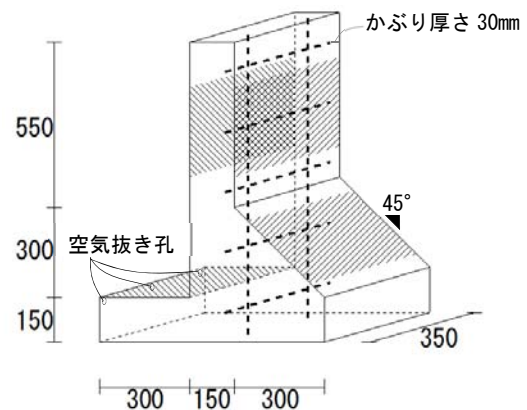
壁模擬試験体の形状 (寸法単位 : mm)
